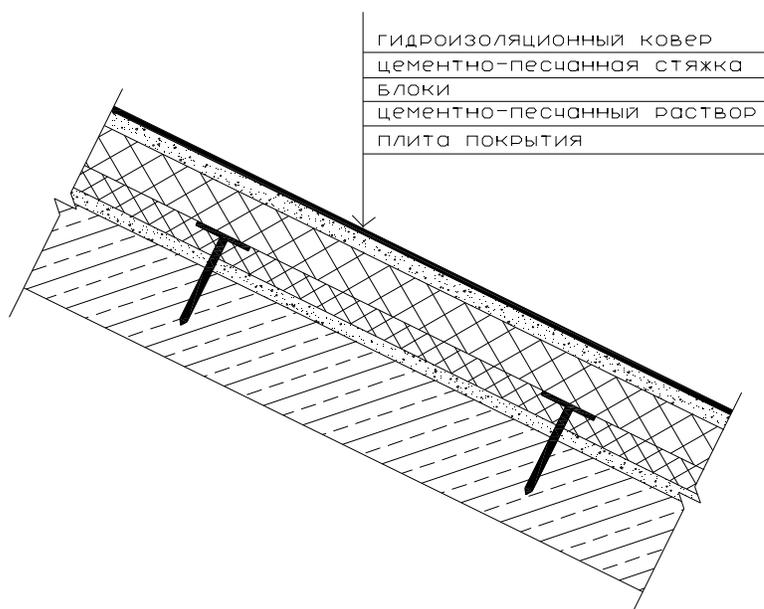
Тепловая изоляция совмещенной кровли с уклоном более 25%
